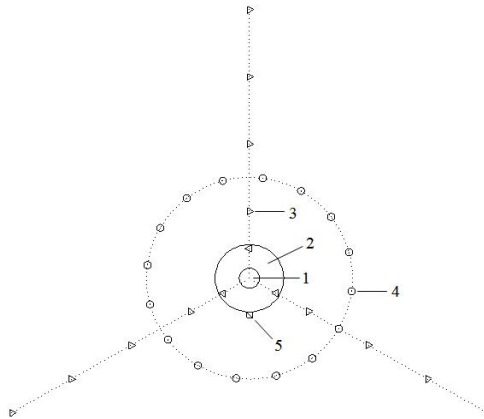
砂井浸水试验各标点布设平面示意图
